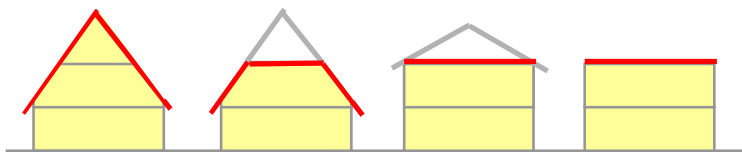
Wärme übertragende Dachbauteile
